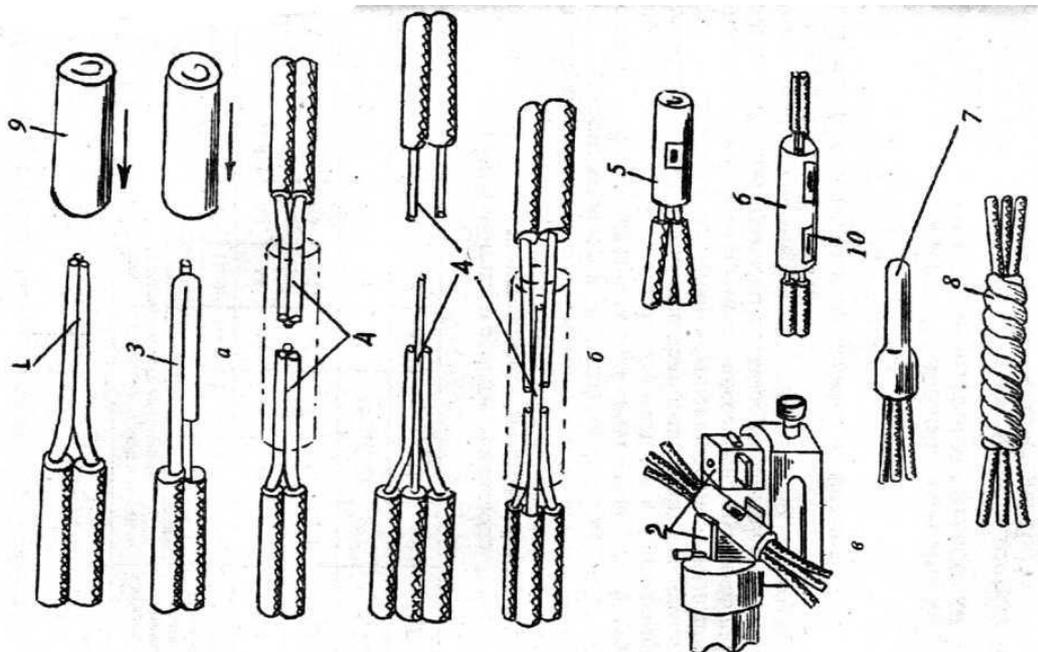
Опресовка при помощи гильз (втулок): 1 - очищенные жилы; 2 - приспособление для опрессовки; 3 - увеличение объема спрессовываемых жил при помощи загибки концов; 4 - варианты сочленений жил при опрессовке; 5 - втулка для односторонней опрессовки; 6 - втулка для двусторонней опрессовки; 7 - изолирующий наконечник; 8 – изолента; 9 – гильза; 10 - лунки втулок
